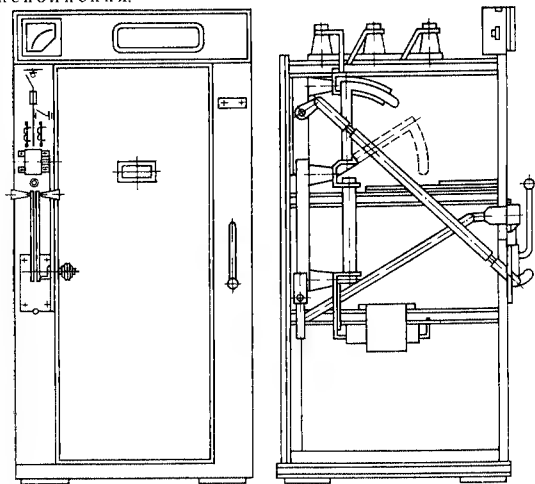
Фасад и разрез камеры КСО-366 с выключателем нагрузки и предохранителями (ВНП-17)
